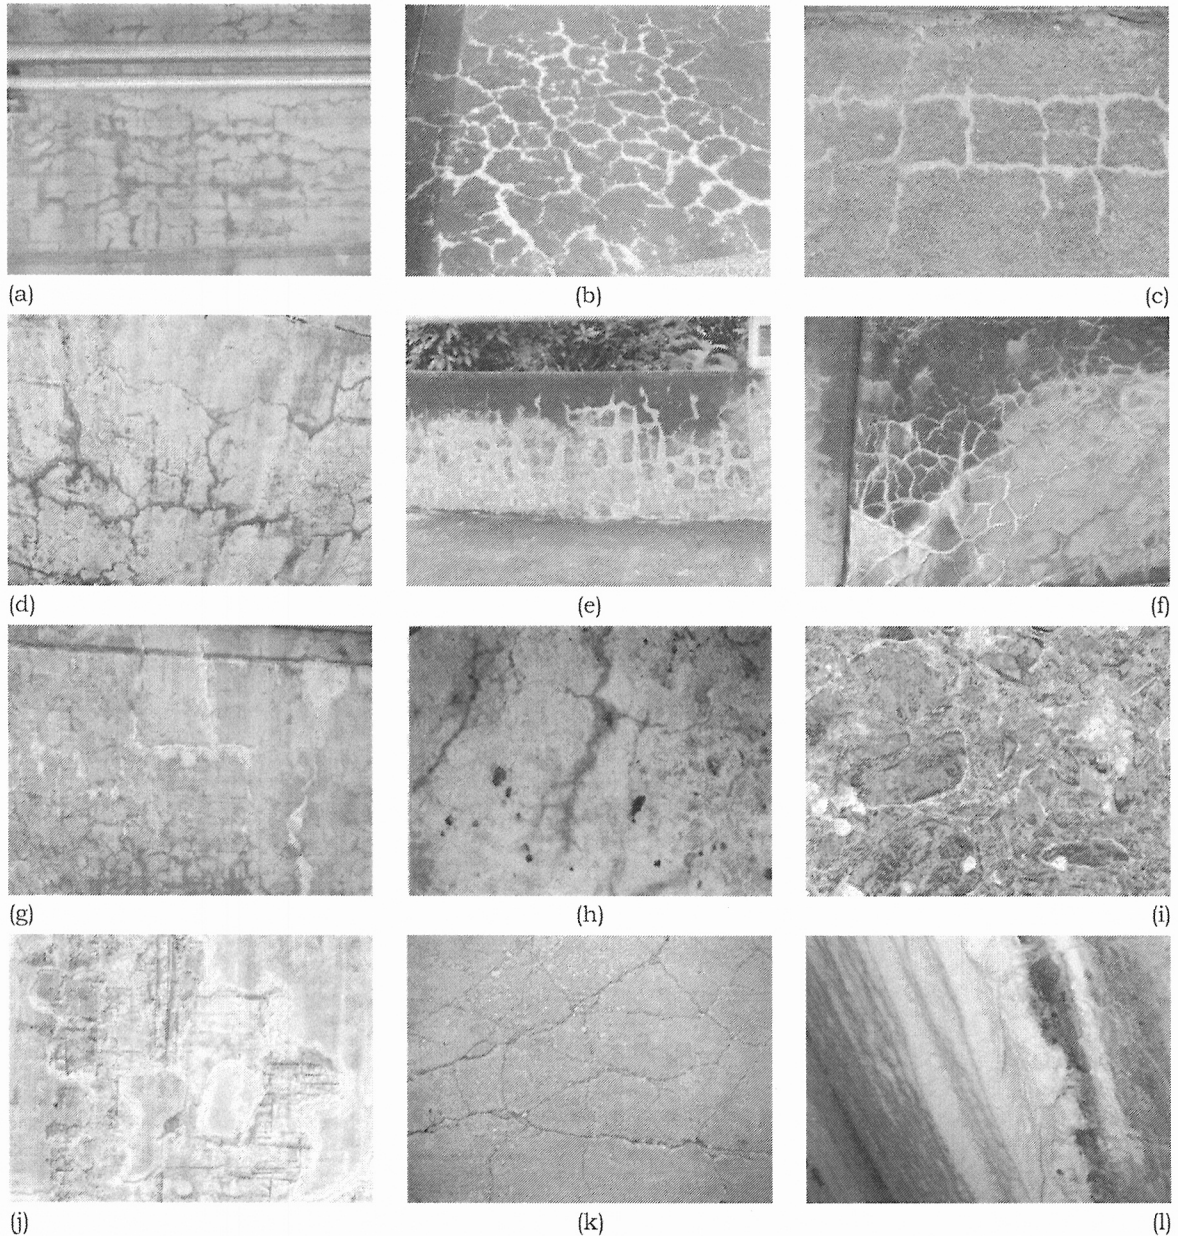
Fisuración reticular con coloración oscura alrededor (a), Fisuración reticular con decoloración en torno a las fisuras (b), Fisuras cuadriculada con decoloración alrededor (c), Fisuración reticular con depósitos anaranjados (d), Muro con diferente coloración y fisuración reticular (e), Muro con fisuración reticulada y depósitos de carbonato (f), Depósitos blancos que deslizan por el muro, junto con fisuración reticular (g), Fisuras con coloración anaranjada y pérdida de pasta sobre áridos oscuros (h), Pérdida de material y depósitos blancos en torno a los áridos (i), Pérdida de material y armaduras sin recubrimiento (j), fisuras reticuladas sin depósitos (k) y depósitos blancos y anaranjados (l).
